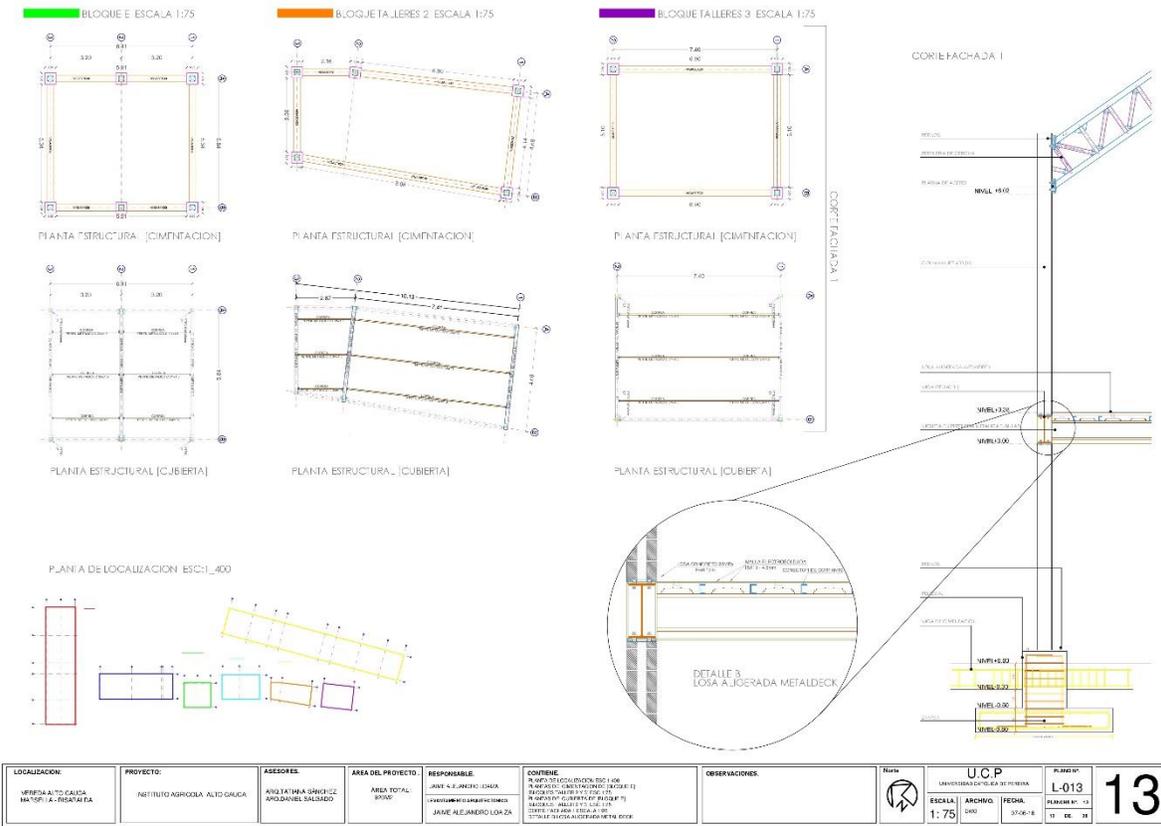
PLANOS: CIMENTACION, ESTRUCTURAL, ENTREPISOS DE BLOQUE ENFERMERIA, BLOQUE TALLERES 2, BLOQUE TALLERES 3, DETALLES.
